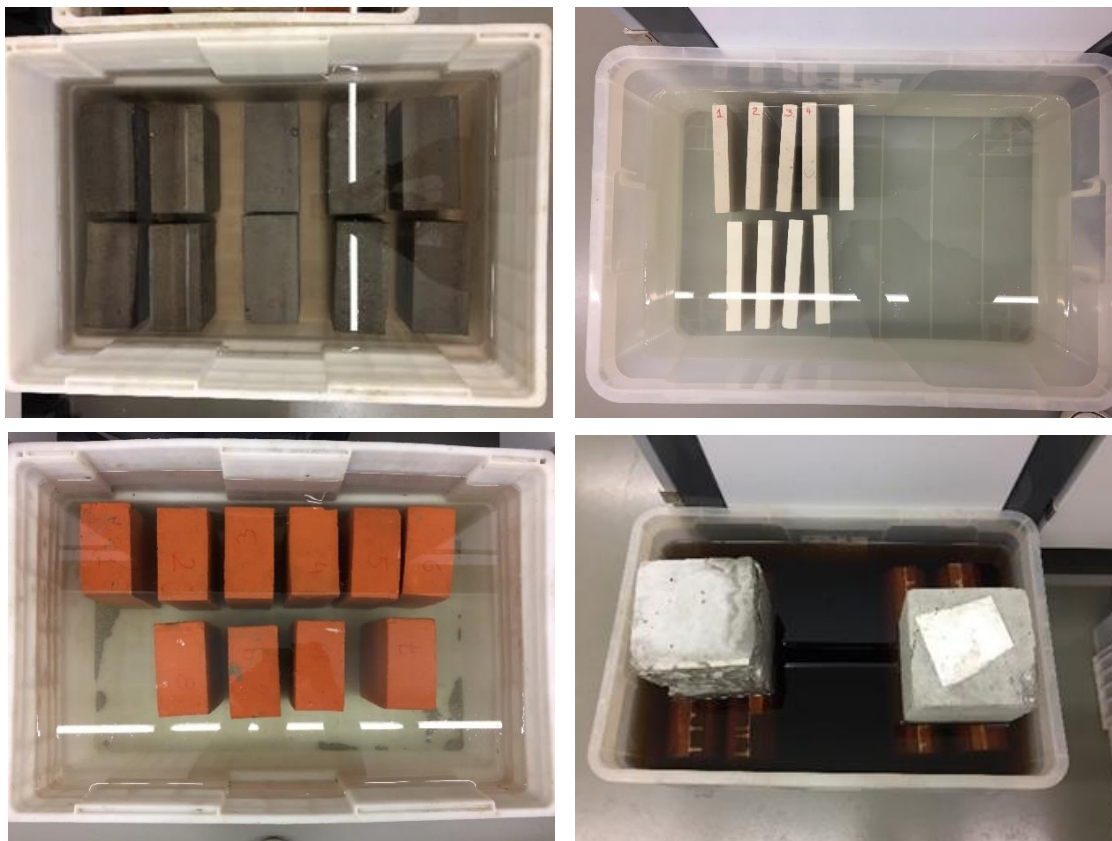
Amostras de Betão, Pedra, Tijolo e Madeira submersas em água
